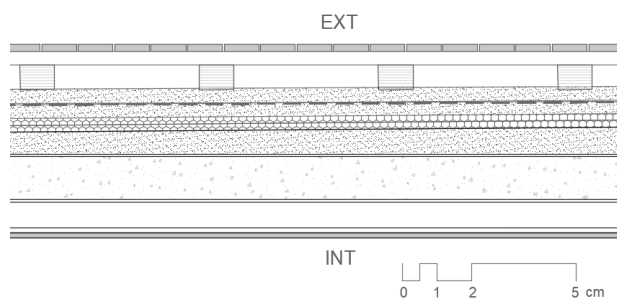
, detalle constructivo de la cubierta del estrato superior. Autor: autoría propia
